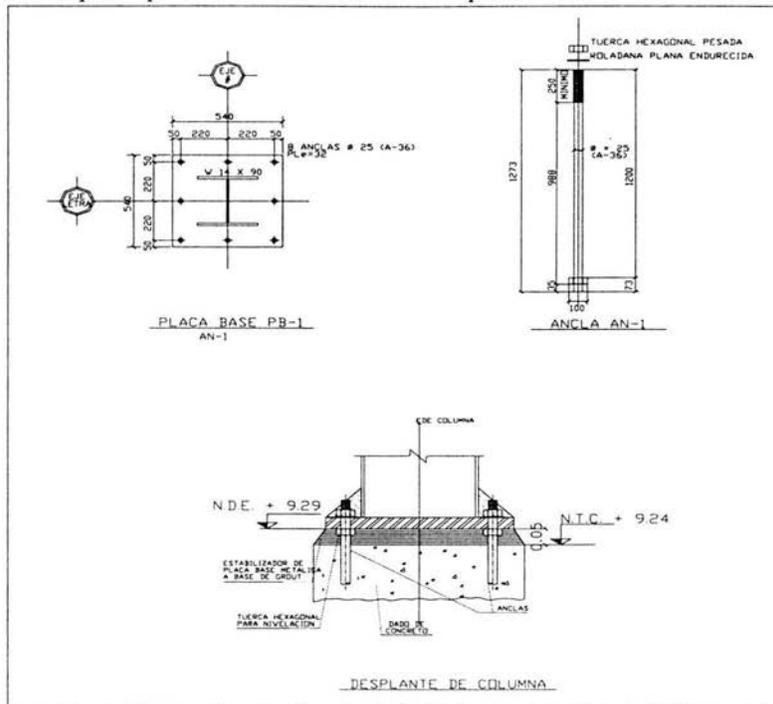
Detalle de placa base y desplante de estructura metálica.
